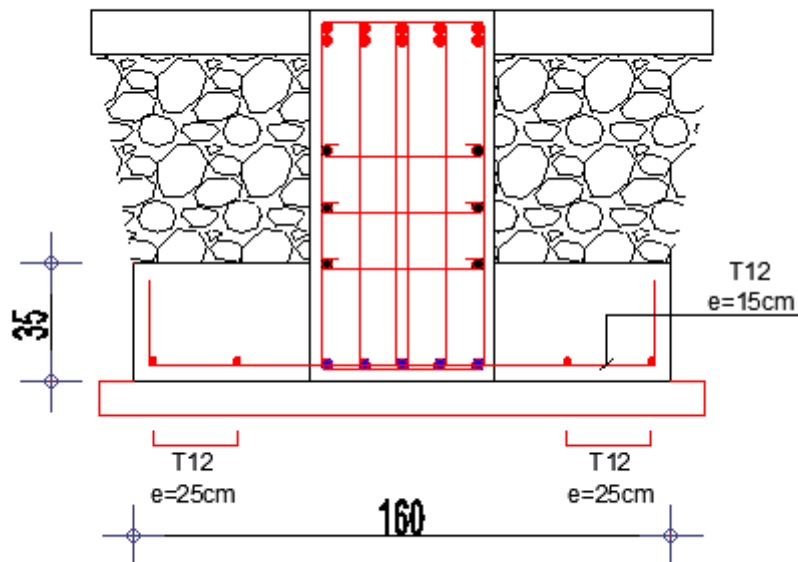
Schéma de ferrailage semelle filent 35X160
